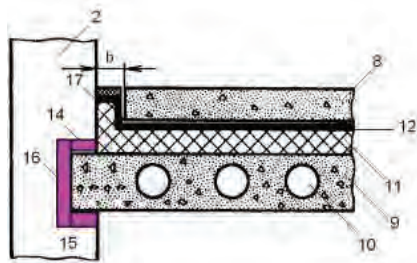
Фрагмент междуэтажного перекрытия здания в разрезе
